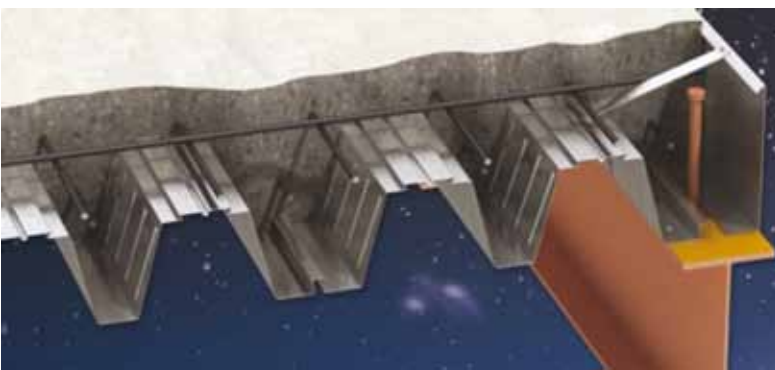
Варианты профнастила для сталебетонных перекрытий с различными выштамповками
